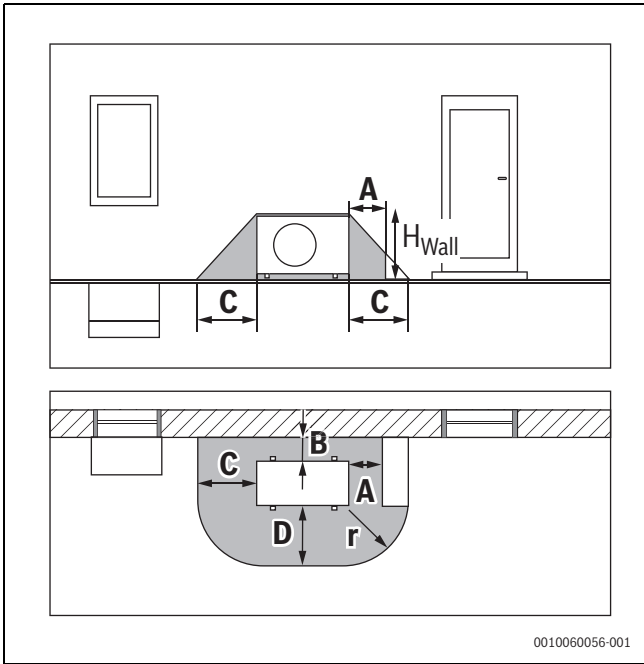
Schutzbereich, bodenstehende Wärmepumpe an der Wand mit seitlicher Barriere
